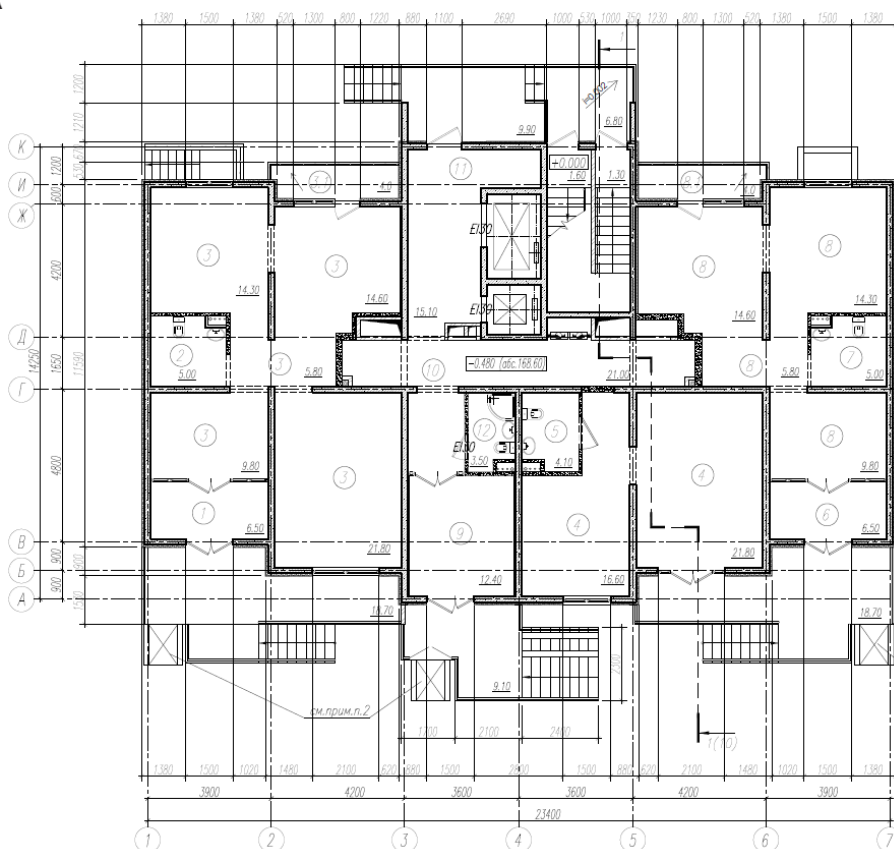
План 1-ого этажа 5 литеры ЖК «Горный квартал»
